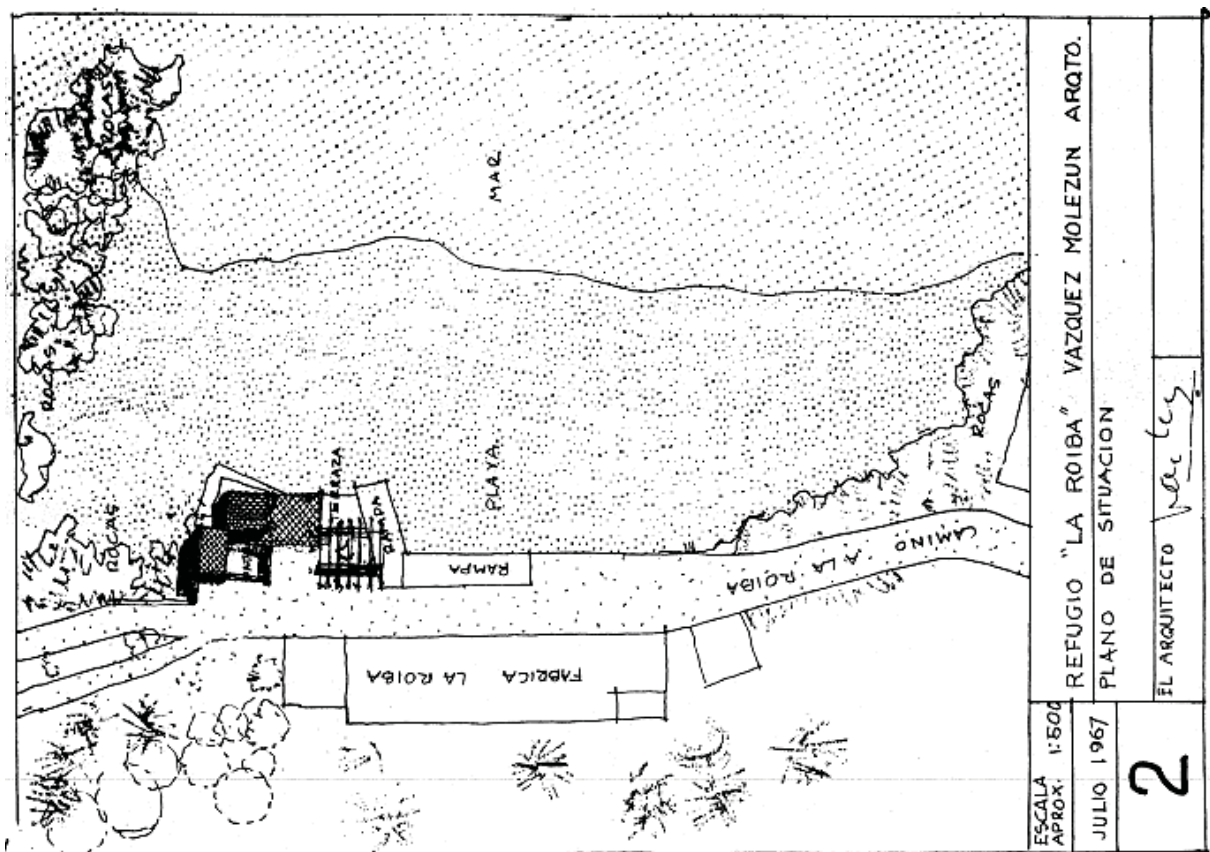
Croquis del arquitecto, correspondiente a la planta de La Roiba. 1.967. Archivo Molezún
